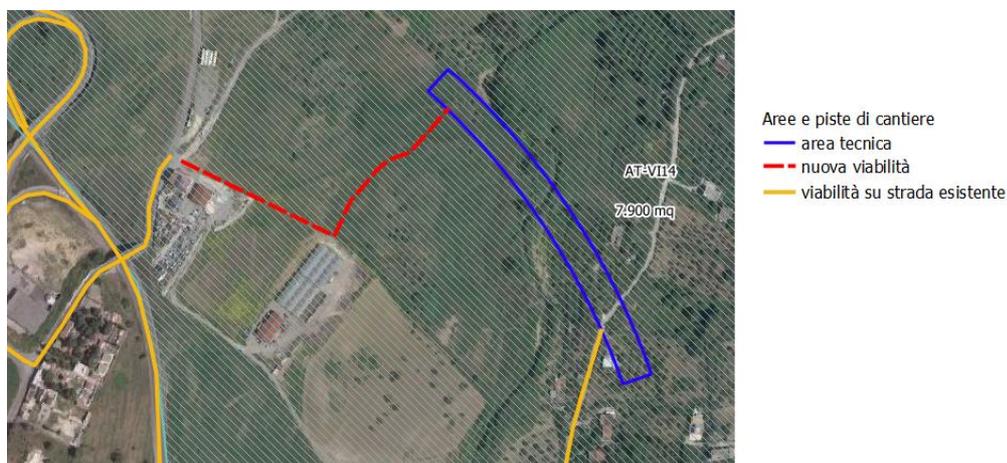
localizzazione della pista di cantiere rispetto l'area vincolata
